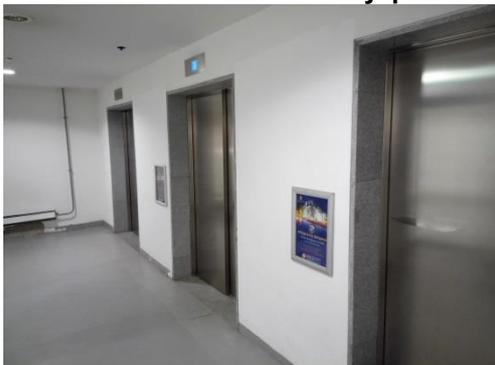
Состояние внутренней отделки помещений, расположенных в подземном этаже
